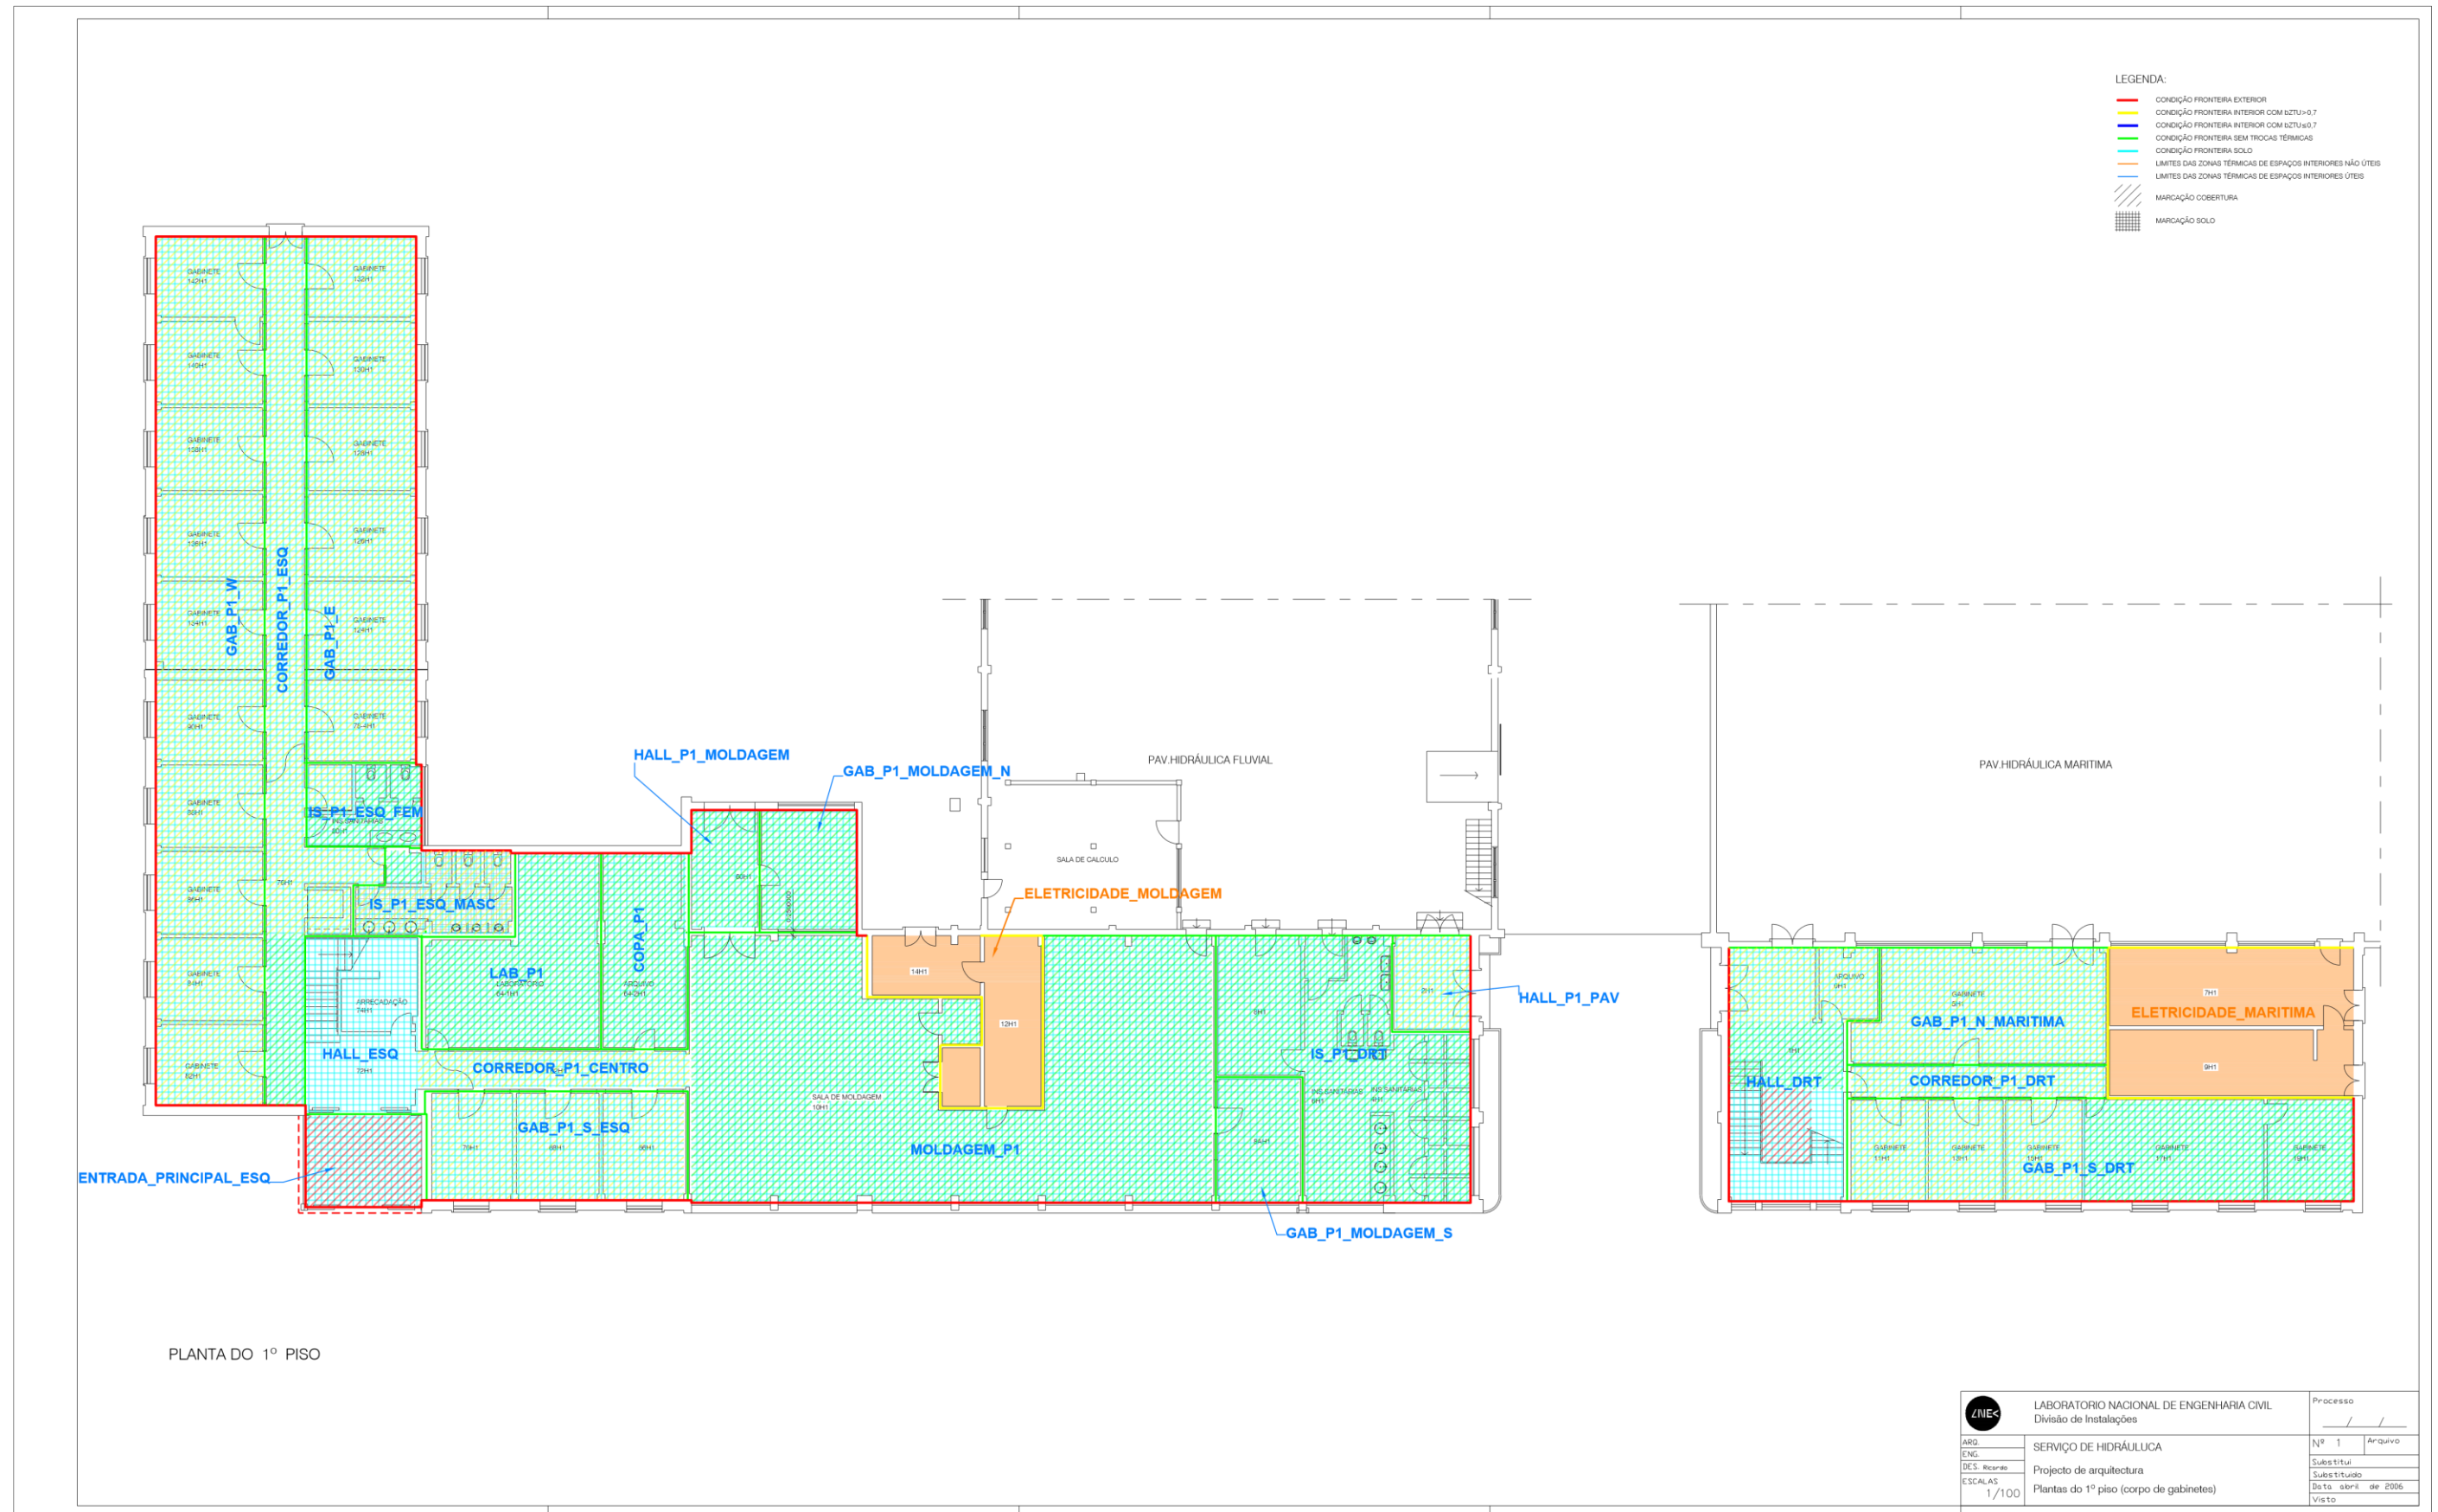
Figura – Planta do 1º Piso: Identificação das zonas térmicas
